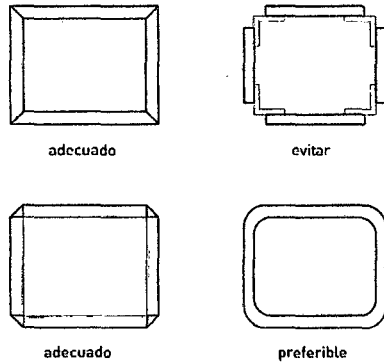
Se observa la vista en planta la continuidad de cordones de soldadura para minimizar el riesgo de corrosión. (Referencia, Enciclopedia Broto de patologías de la construcción, 2004).
